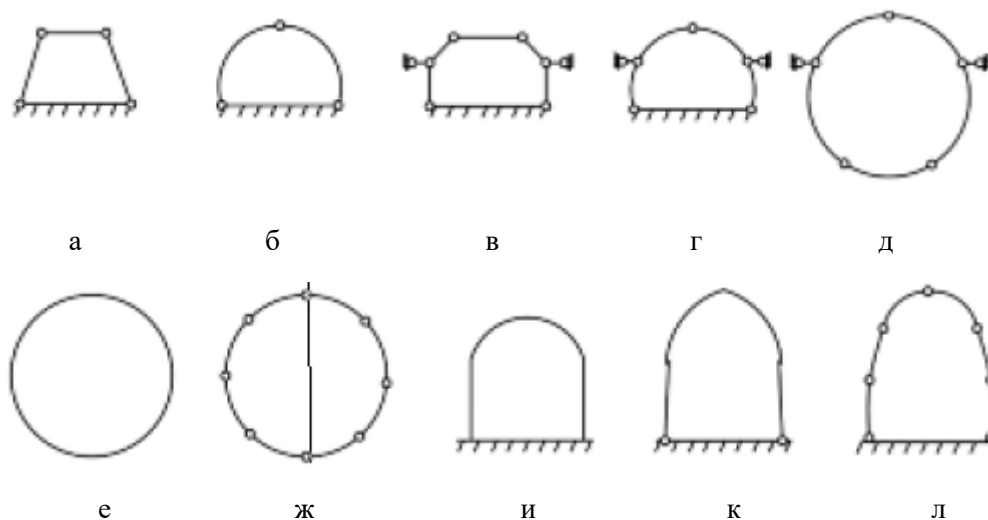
Розрахункові схеми кріплень підземних виробок:
